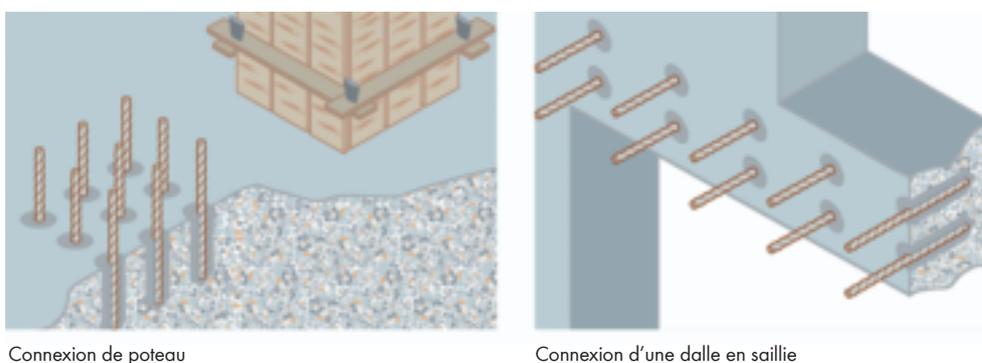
exemples d'application de scellement de barres d'armatures.
